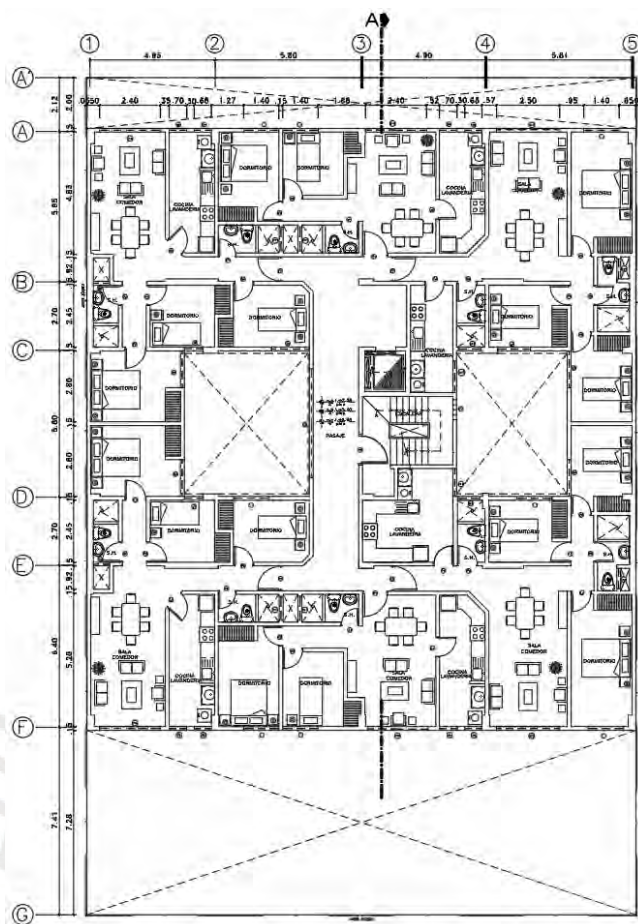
Arquitectura de planta de piso típico (2do a 4to nivel)
